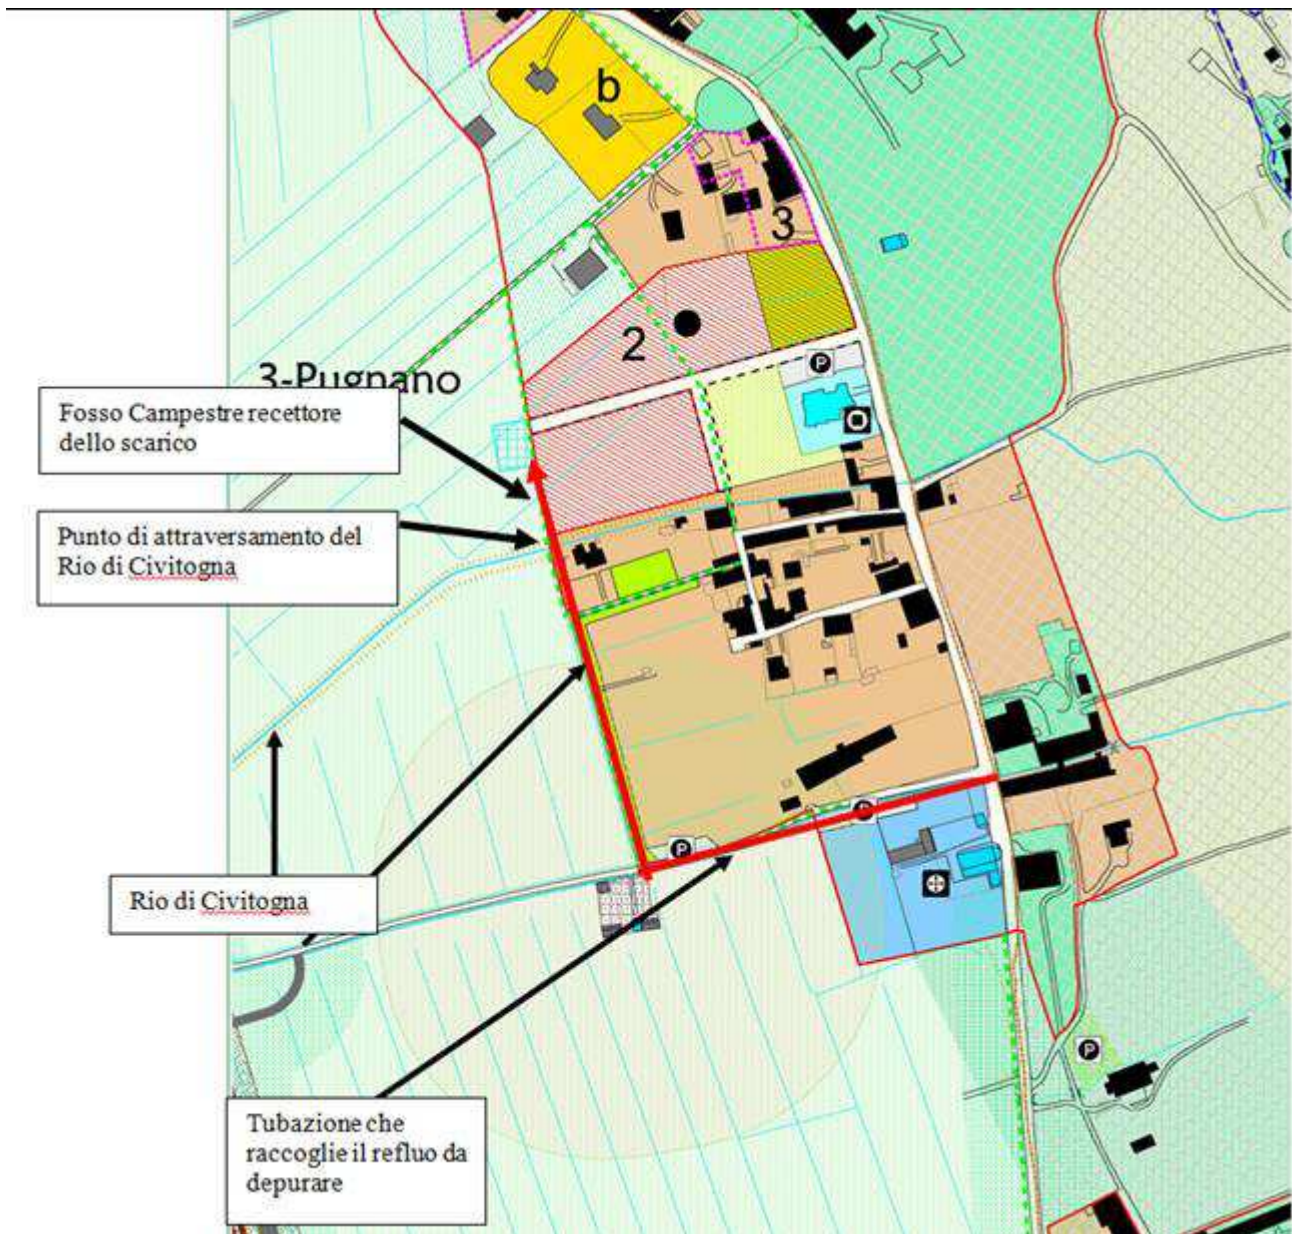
Schema fognario proposto nel progetto preliminare, fornito dal Comune di San Giuliano Terme
